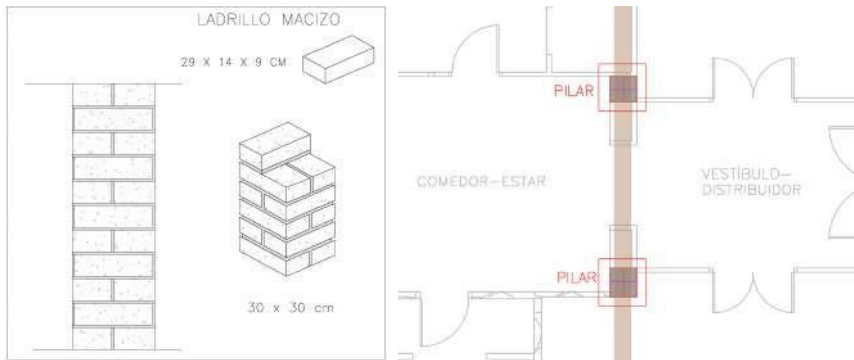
Pilar de ladrillo macizo existente en la vivienda junto a armarios empotrados. Fuente propia
